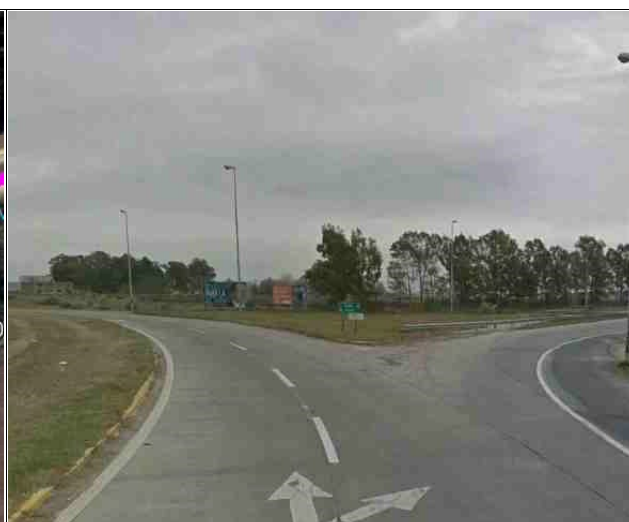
y Foto 207. Intersección RP N°6 con RP N°58
